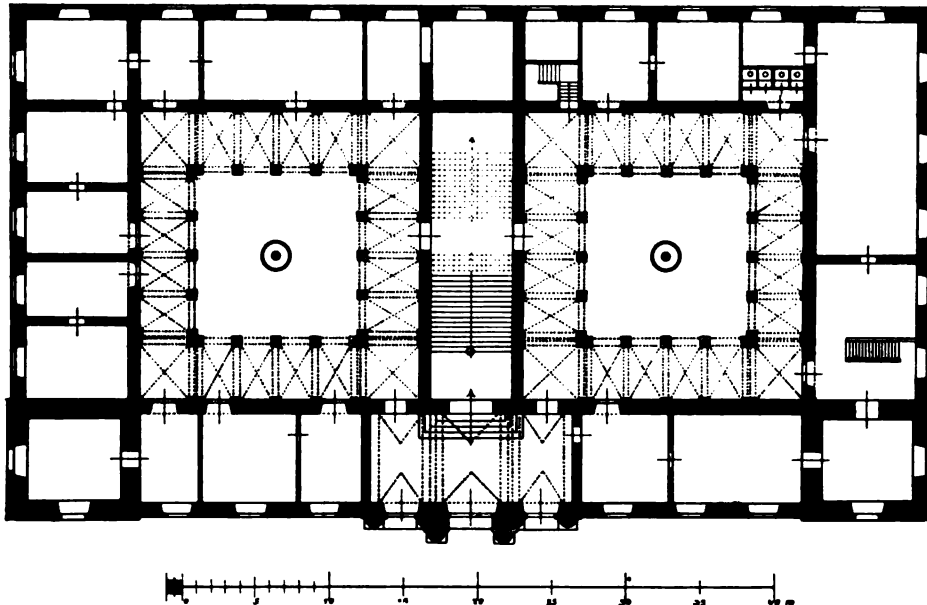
Hofgefängnis in Madrid (Jetzt Staatsministerium) Grundriß
